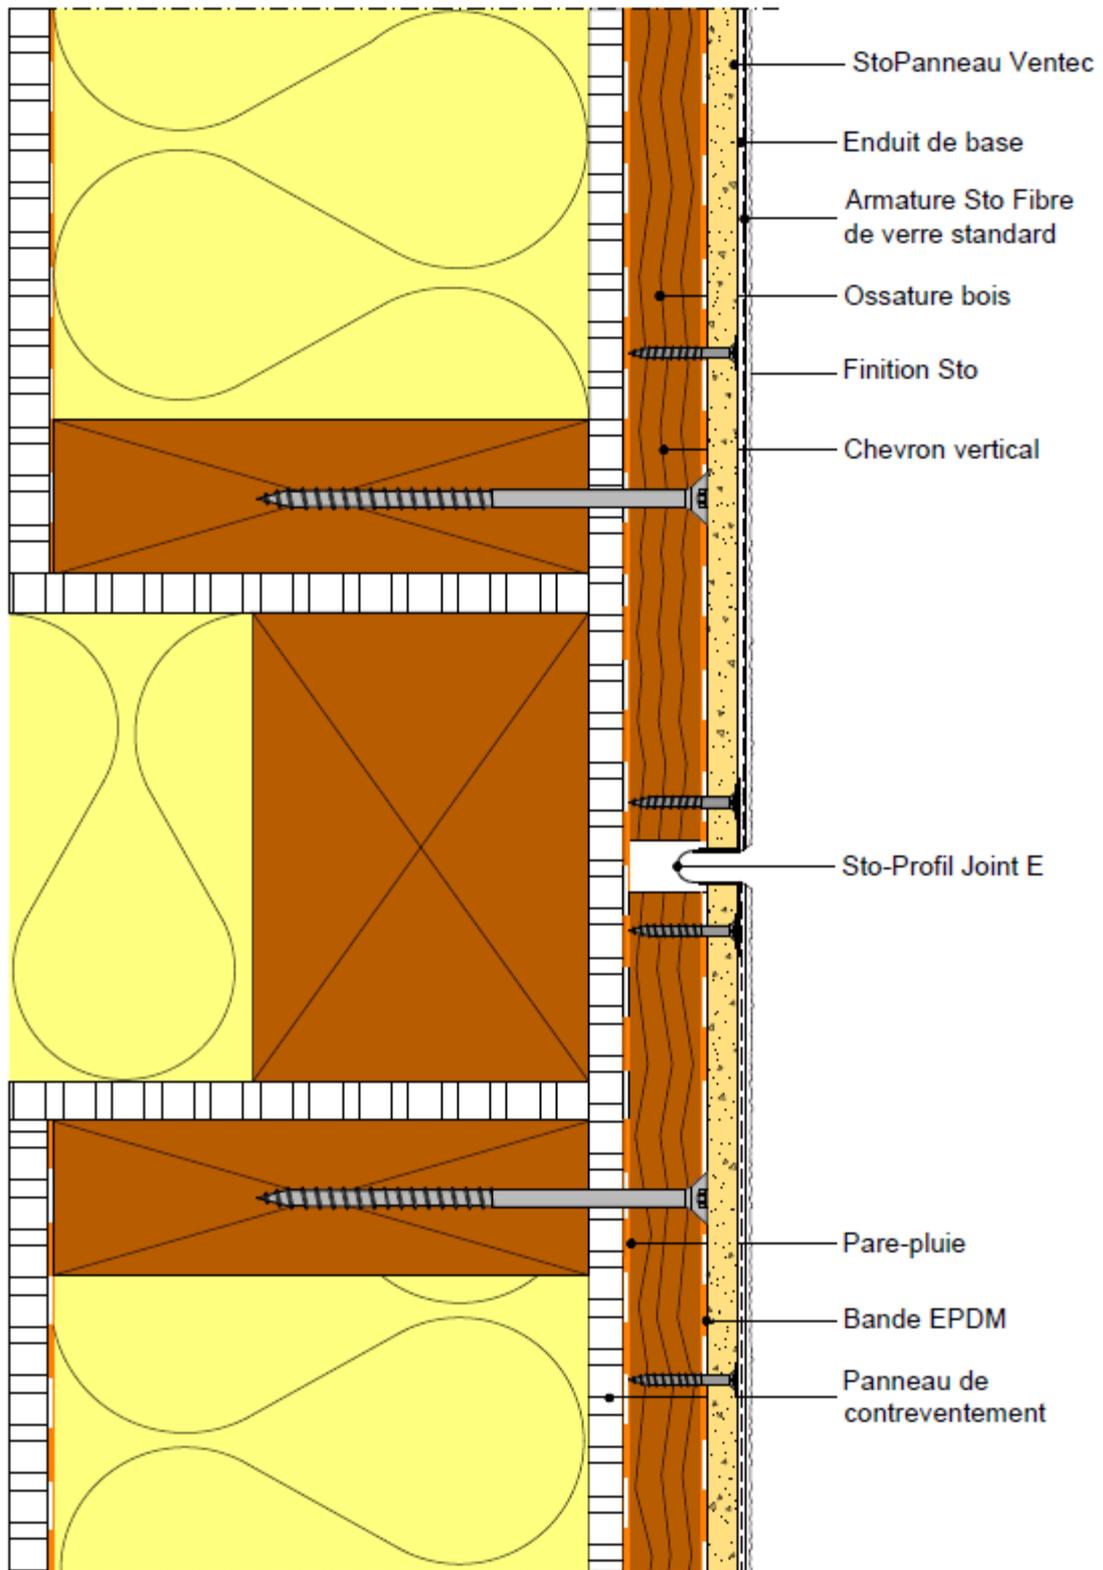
Coupe verticale - Fractionnement du parement au droit d'un plancher - Ossatures bois sur COB
